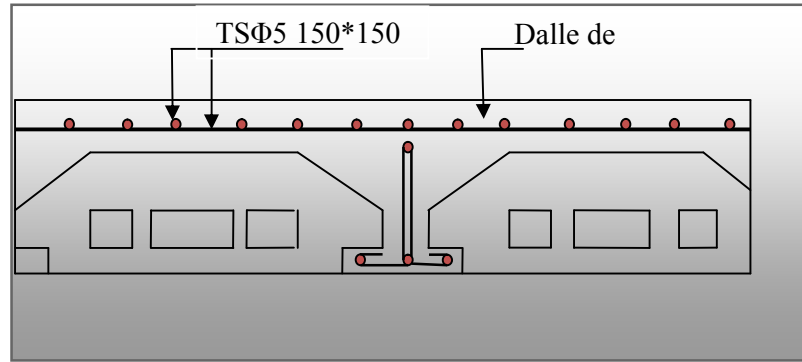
Schéma de ferrailage de la dalle de compression.
